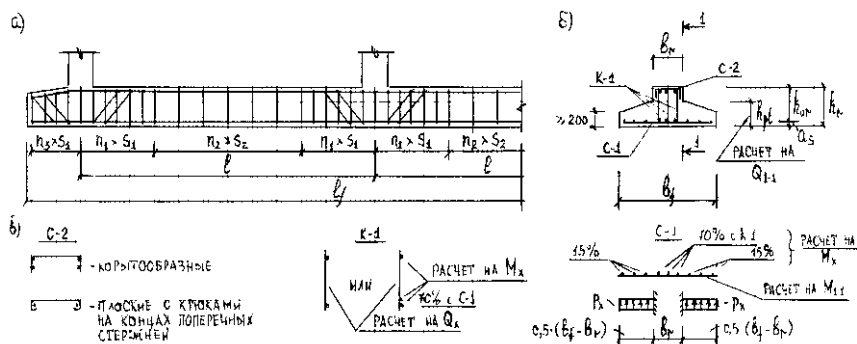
Армирование ленточного фундамента под ряды колонн: а — продольный разрез, б — поперечный разрез, в — корытообразные и плоские каркасы и сетки
